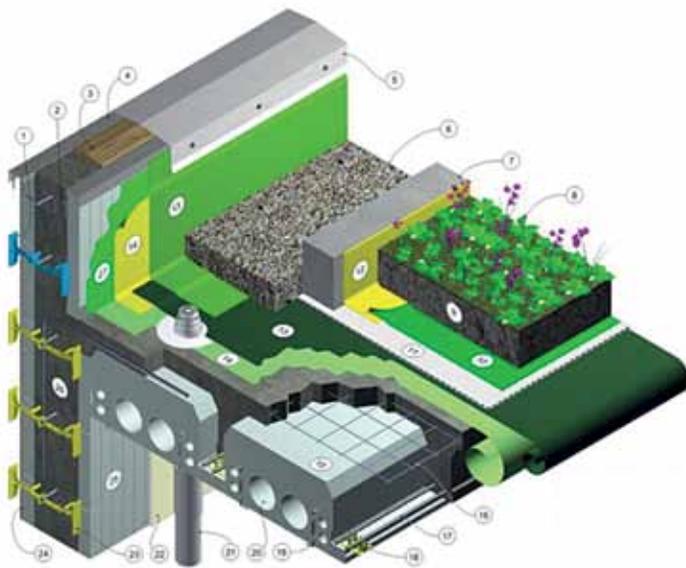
2 Representación de Cubierta Vegetal sobre sistema de losa liviana.
